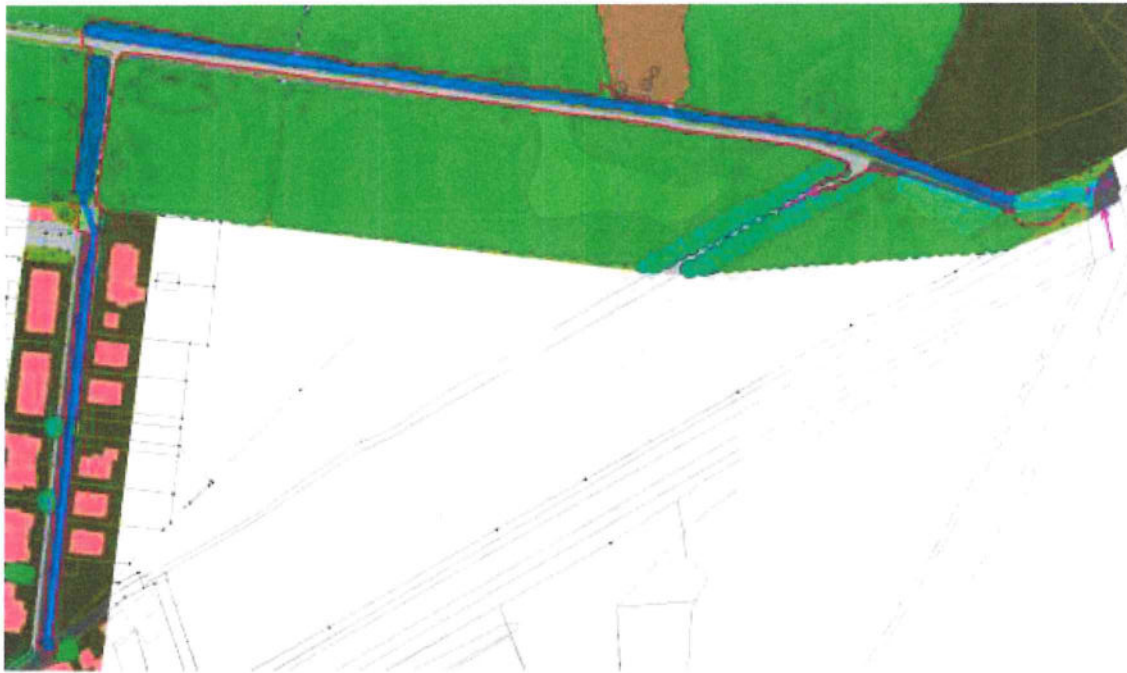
Baugruben (dunkelblaue Schraffur), Baustelleneinrichtungsflächen (hellblaue Schraffur) und Zufahrten (Pfeile in magenta) im Abschnitt Nord.
